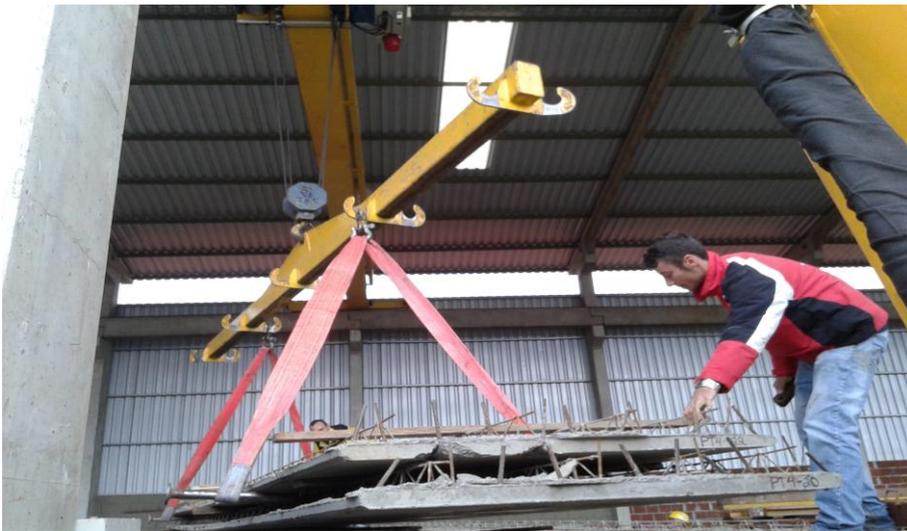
PAINEL TRELIÇADO CONCRETADO
